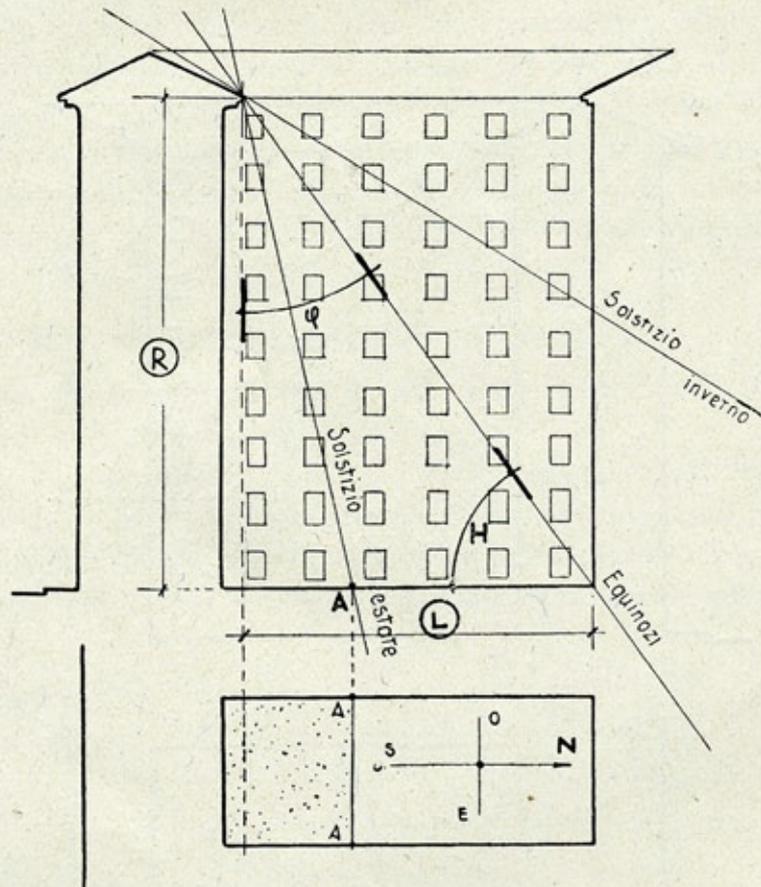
Schema dell'insolazione meridiana di un cortile, parete sud.
